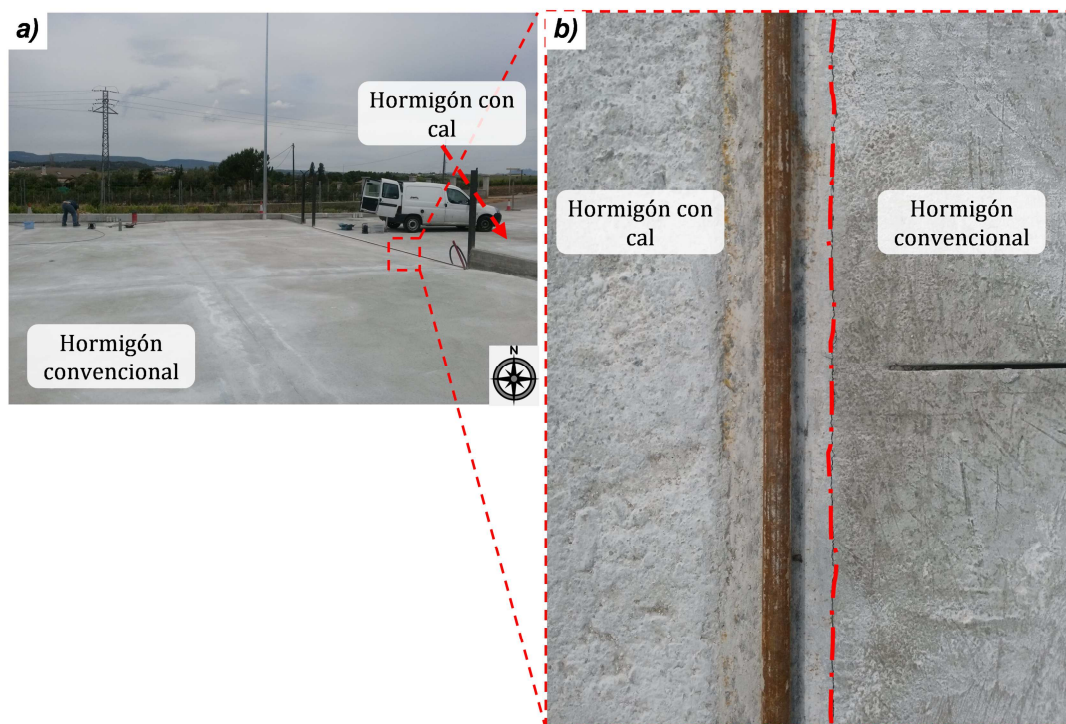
108 – a) vista general de la división entre las losas; b) detalle de la junta entre los hormigones y el elemento metálico de la puerta de acceso
